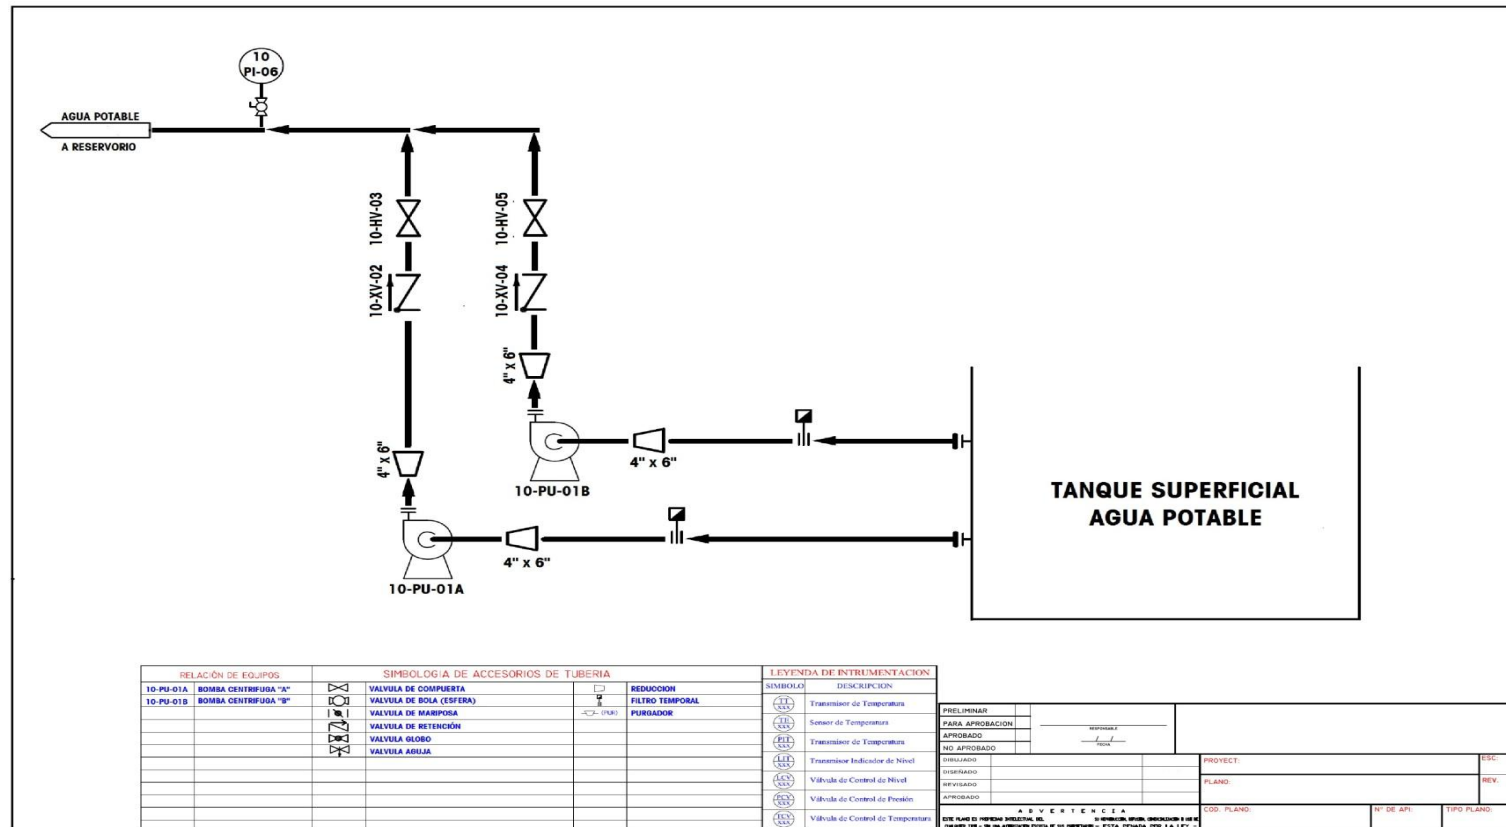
Plano P&ID de la Planta de Tratamiento
